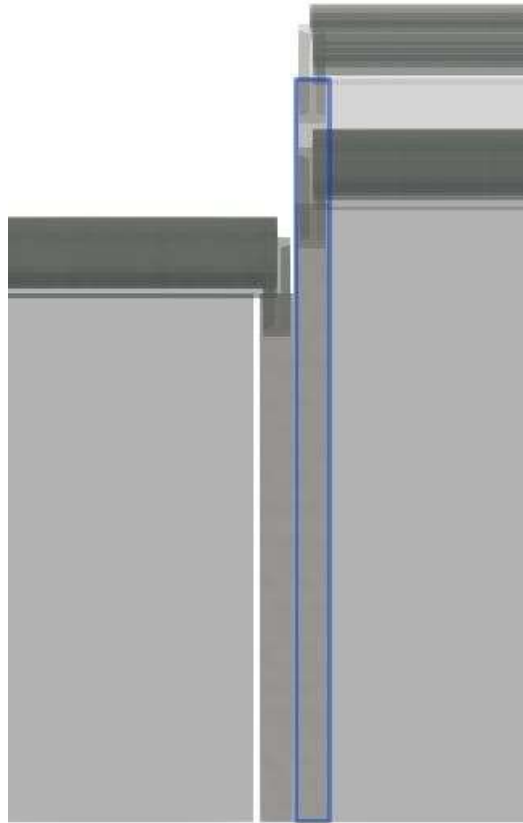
Zona di interesse della seconda soluzione vista laterale
